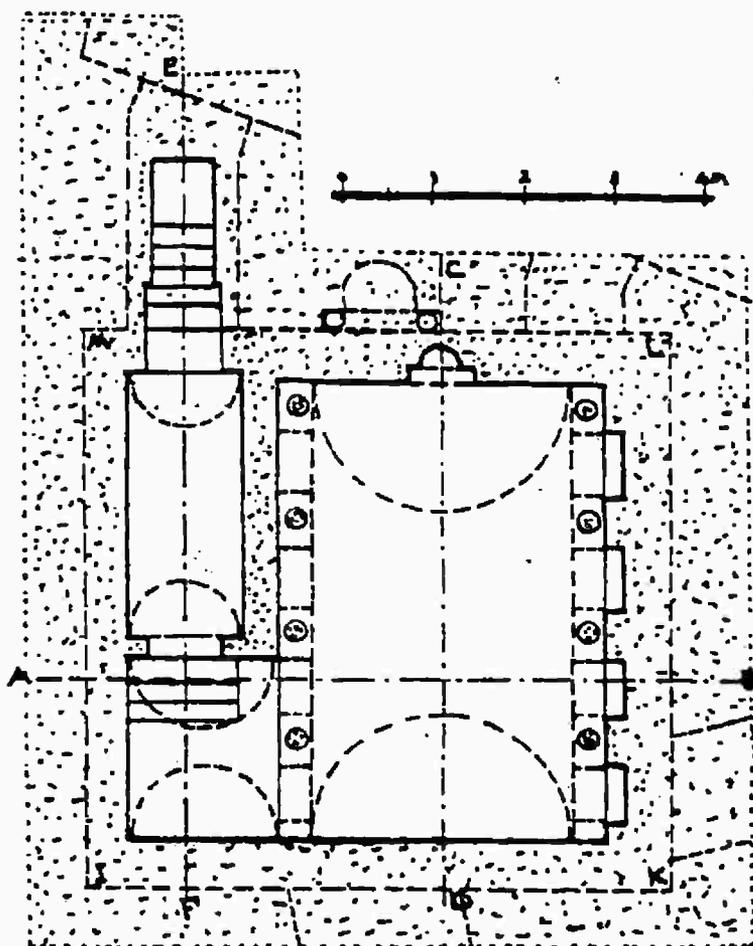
مسقط أفقي لقبة الإمام الشافعي
